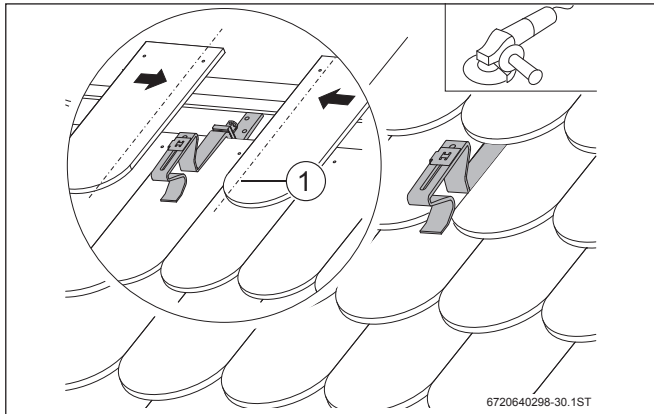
Haki dachowe przykręcone na krokwiach dachowych
